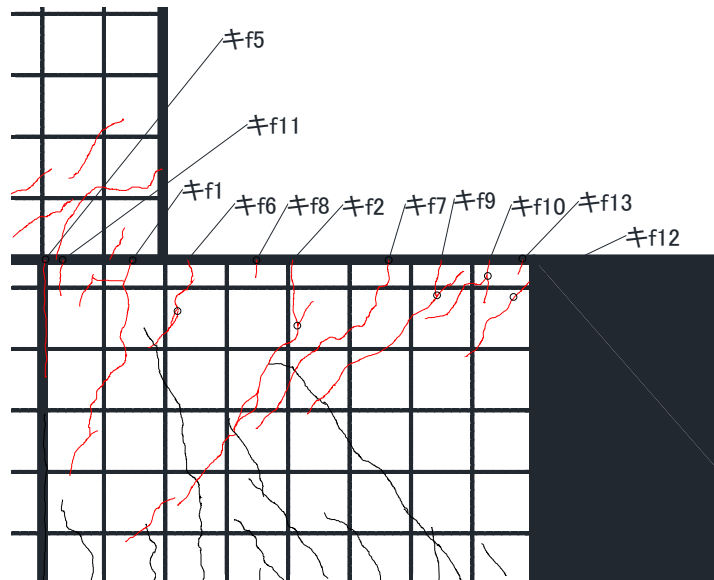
基礎梁ひび割れ幅測定位置 (試験体 DR-4 -7.0 サイクル 観測面)
